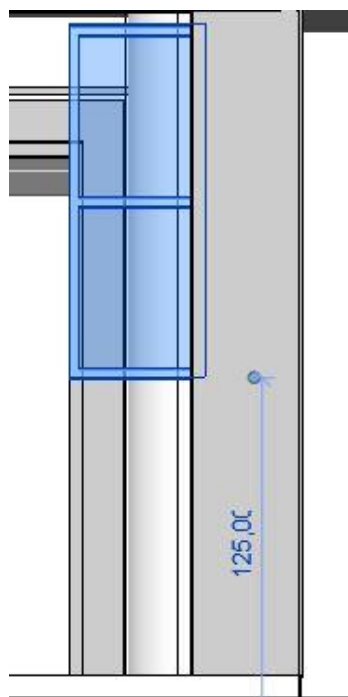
Conflito do Pilar P29 com a esquadria J9 em vista
